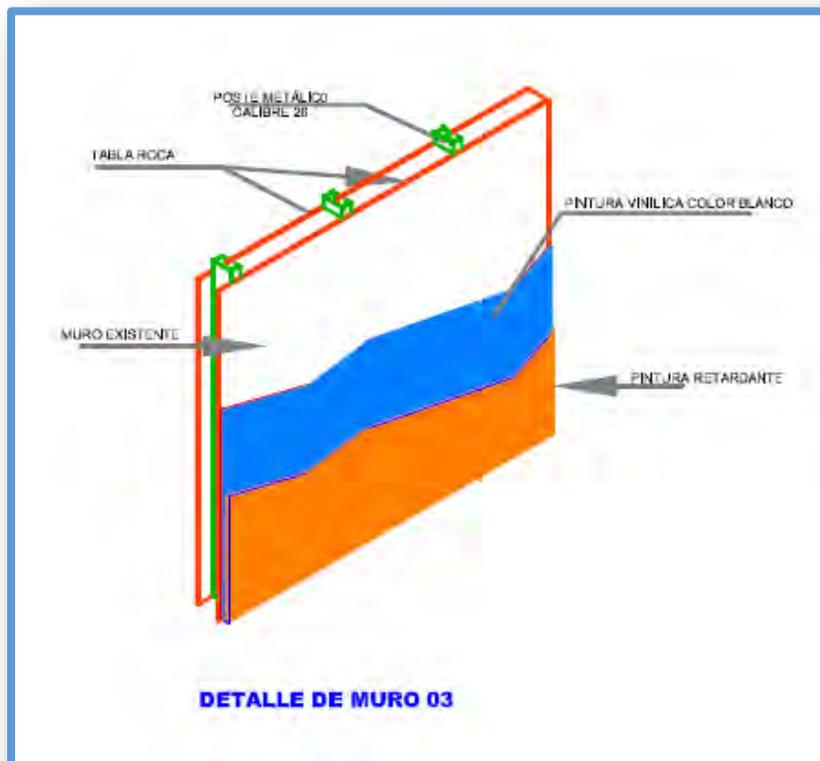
Detalle arquitectónico del muro 03 del *Data Center*.
